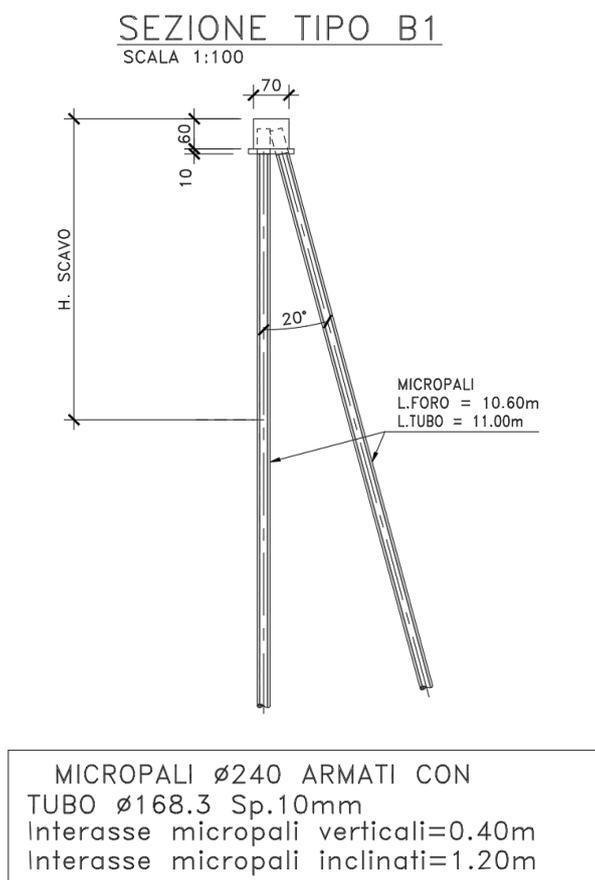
Sezione Paratia "Sezione tipo B1"
